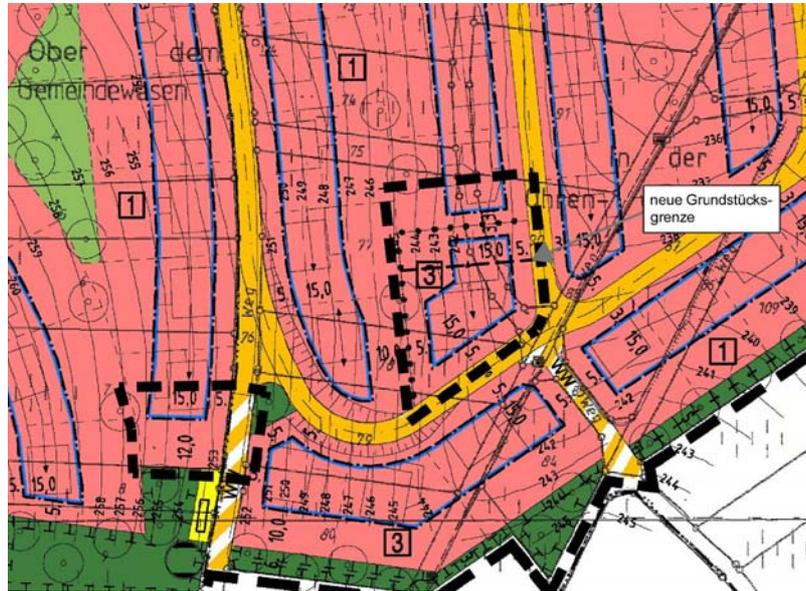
Rechtskräftiger Bebauungsplan (mit den ursprünglichen Grundstückseinteilungen)
